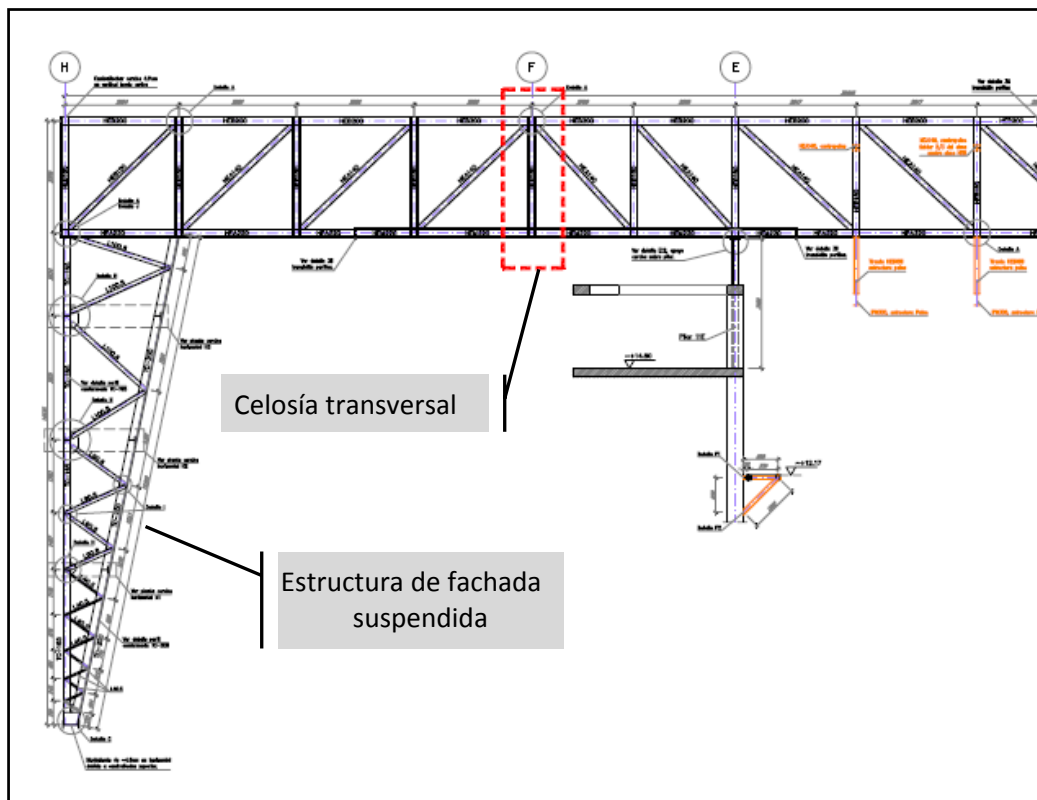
Alzado de voladizo del proyecto real (Eje 11)
